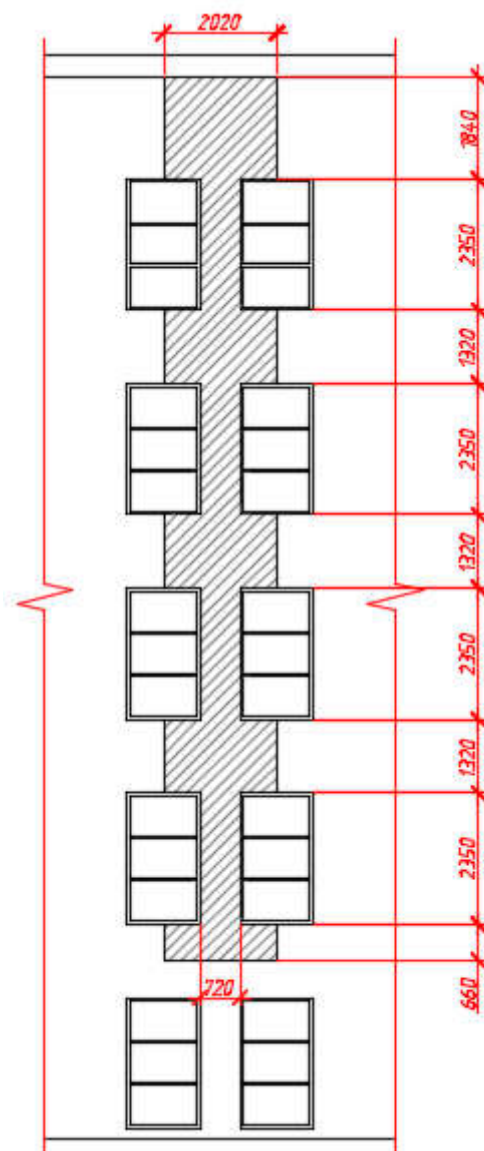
Схема сбора нагрузки от собственного веса стены
